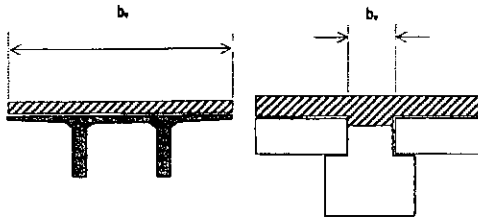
Ejemplos del ancho de contacto entre el elemento prefabricado y la losa colada en sitio
